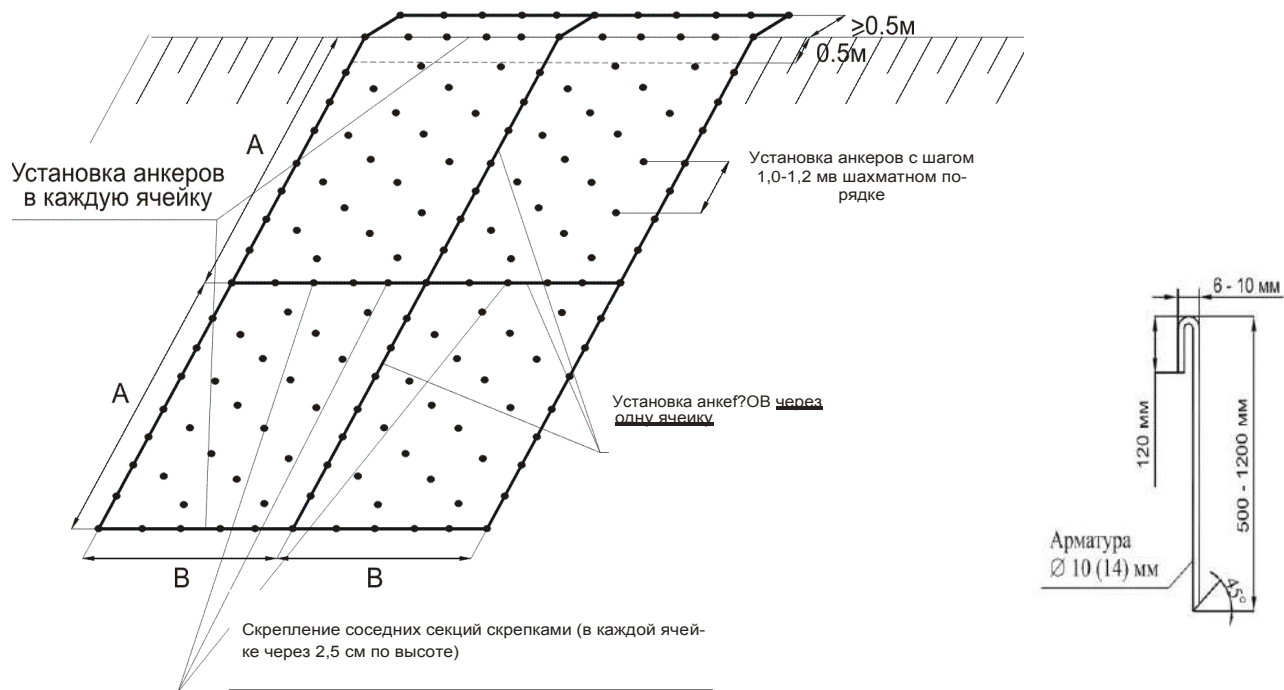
Типовая схема укладки и крепления георешетки
